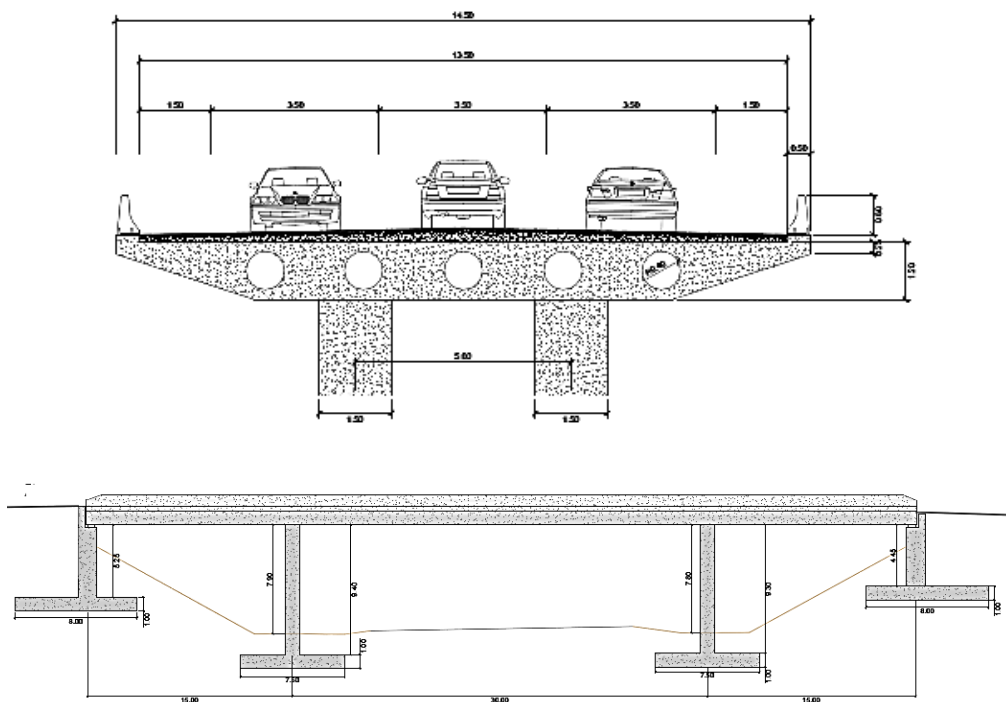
Sección tipo y sección longitudinal del Puente 4
